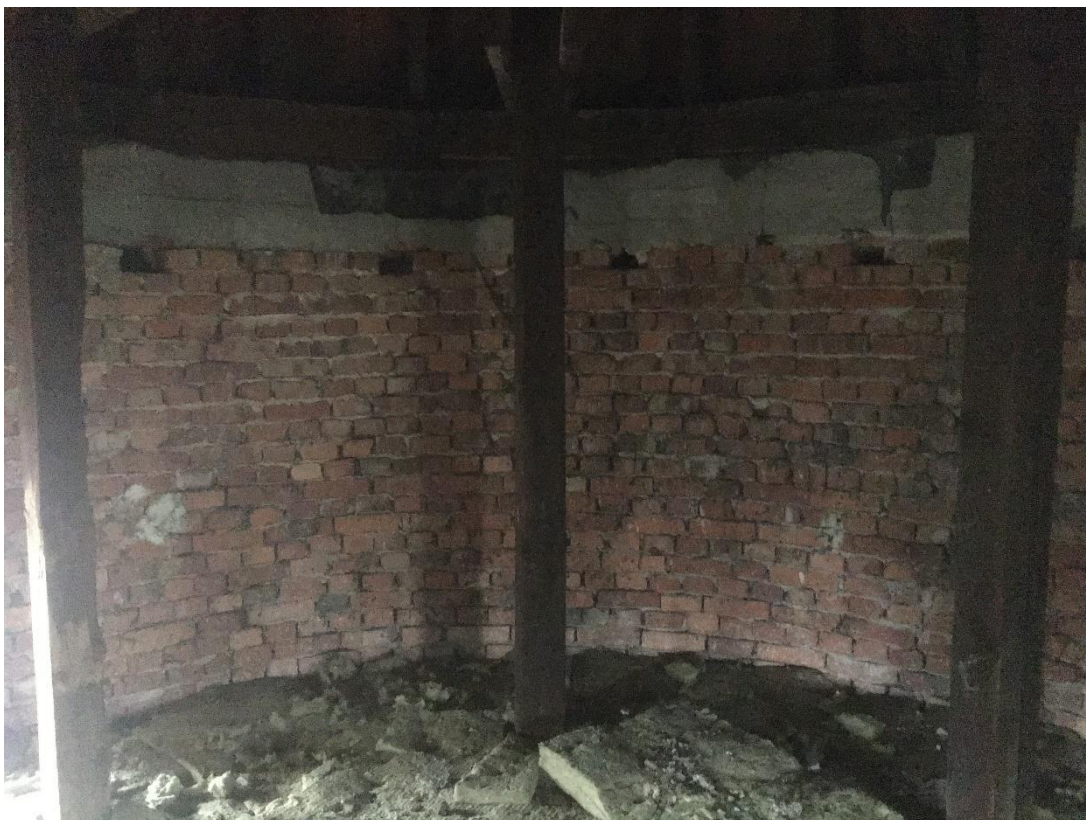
Więźba dachowa, krokwie, widoczne zabrudzenia, stan zachowania dobry.
